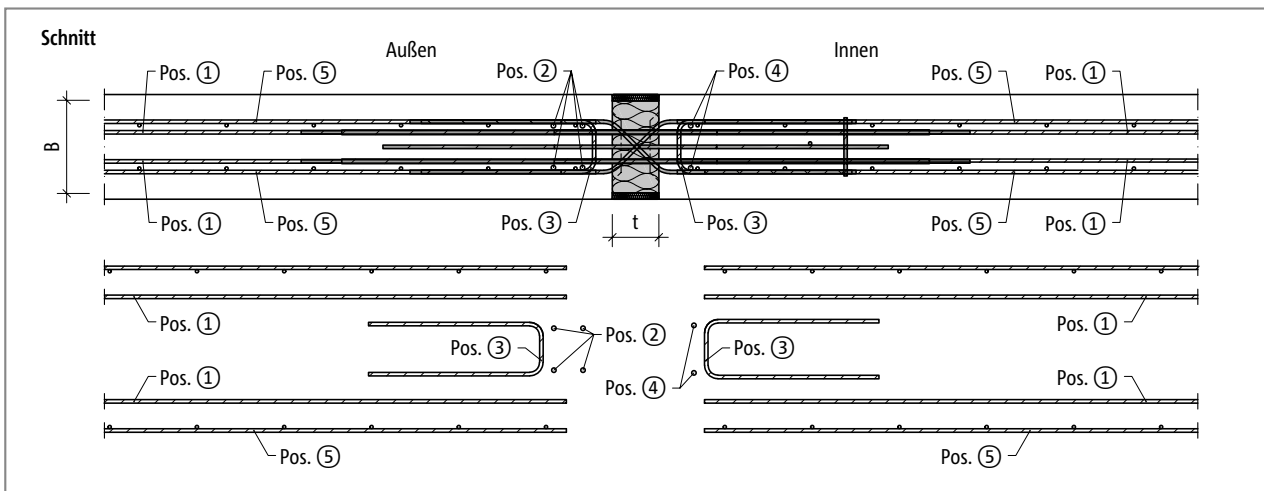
Schöck Isokorb® T Typ W: Bauseitige Bewehrung (Grundriss)
